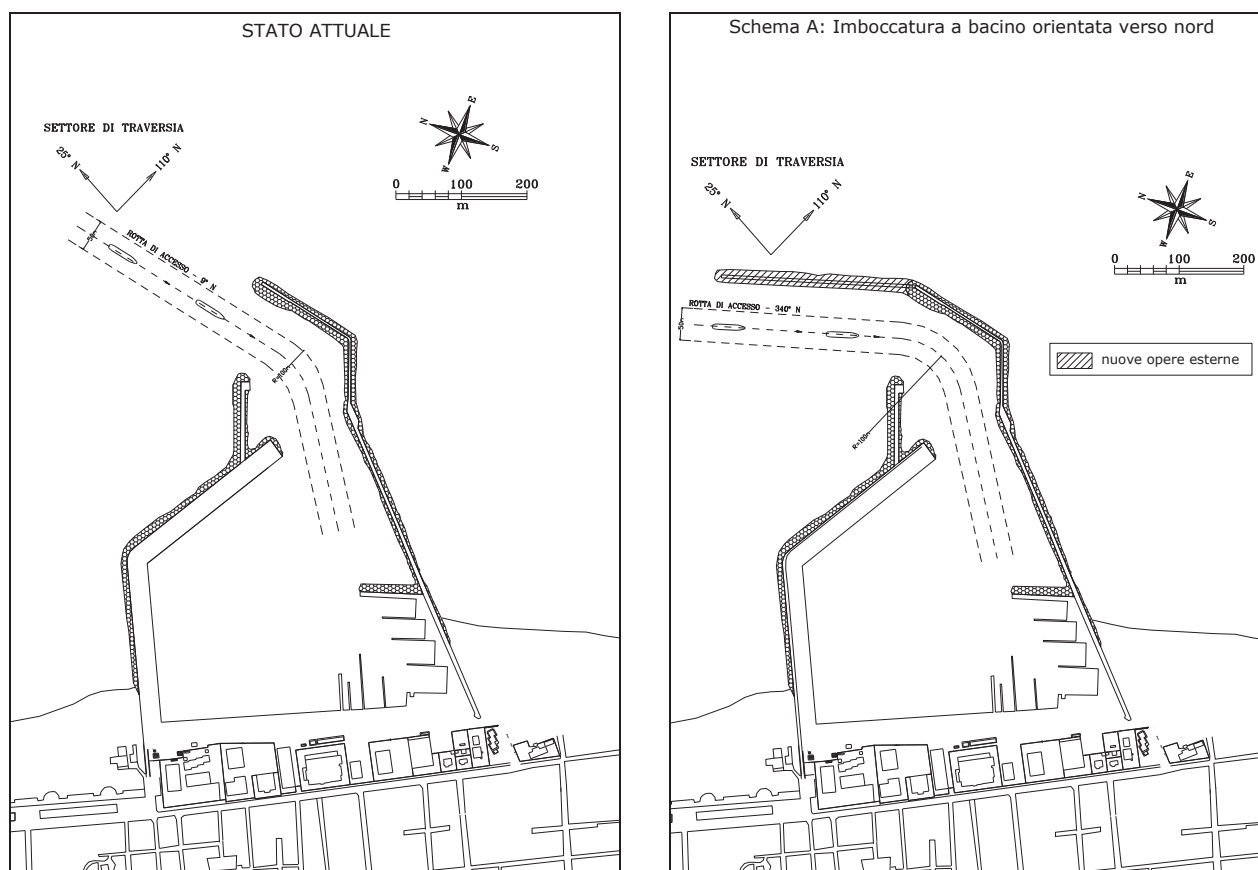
Layout di imboccatura portuale: schema attuale e schema A
